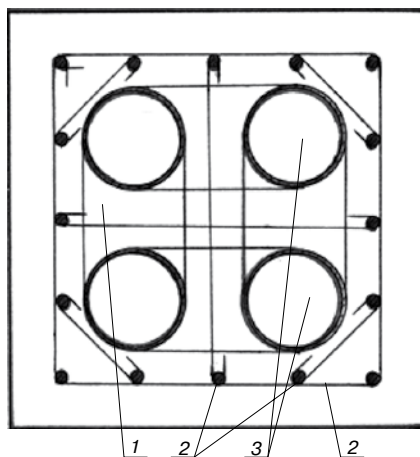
Вариант поперечного сечения колонны 900×900 мм с четырьмя трубобетонными элементами круглого поперечного сечения: 1 – бетон; 2 – гибкая арматура; 3 – трубобетонные элементы
